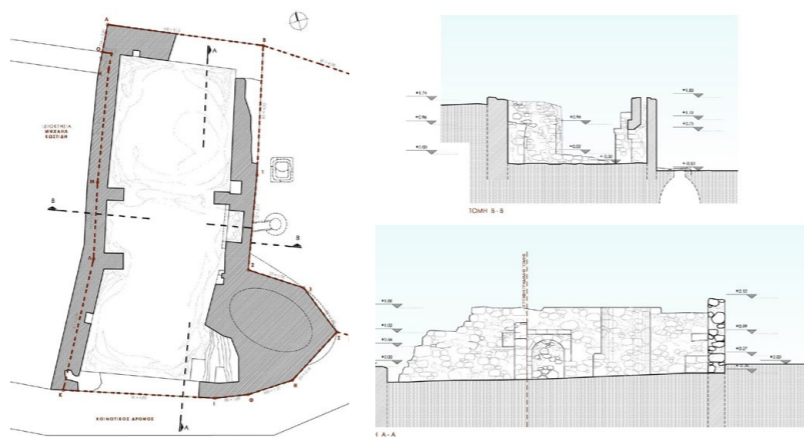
Planta y sección de la vivienda en ruina antes de la intervención.
